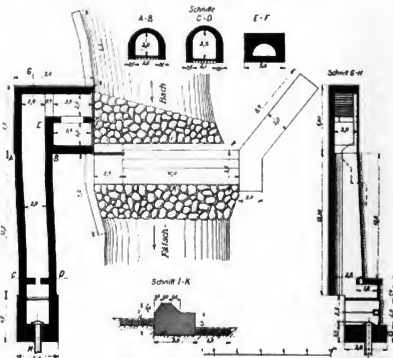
Die Wasserfassungsanlage. Grundriss und Schnitte. — Massstab 1 : 300.
